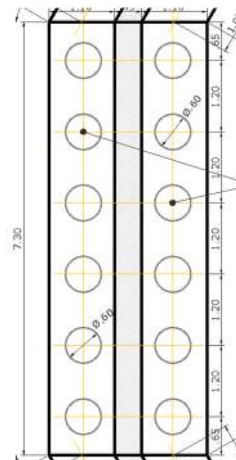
Distribución y cantidad de pilotes de concreto reforzado de 0.6m. de diámetro y 6m. de largo para cimentar cada estribo del puente de concreto reforzado en la abscisa K3+615.
